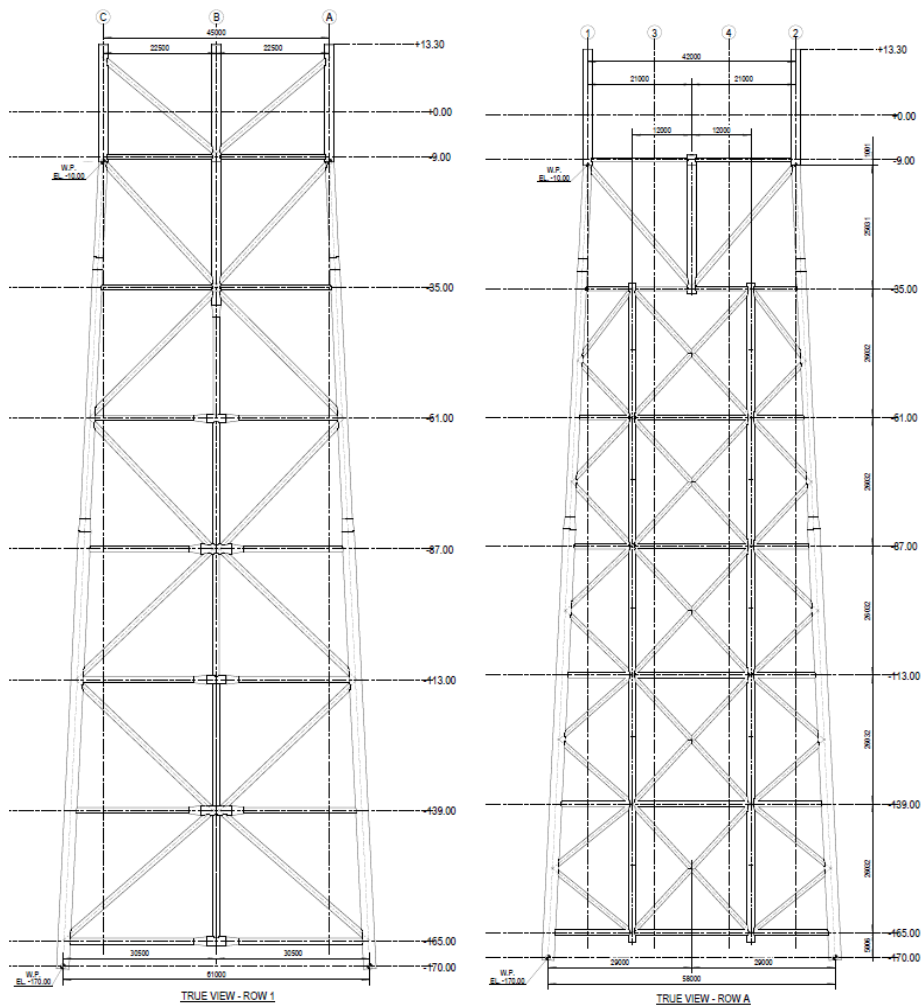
Jacket - vista da Ovest (Row 1) e da Sud (Row A)
